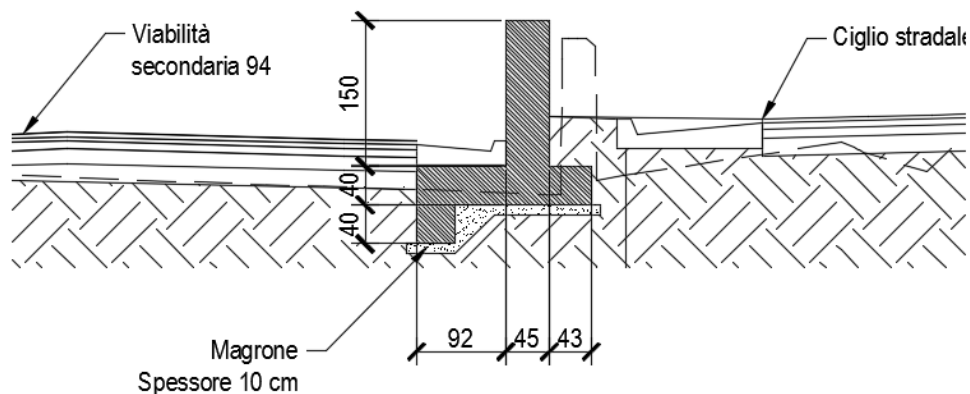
Sezione trasversale del muro spartitraffico tra viabilità principale e secondaria (OS01) (TIPO 3).
